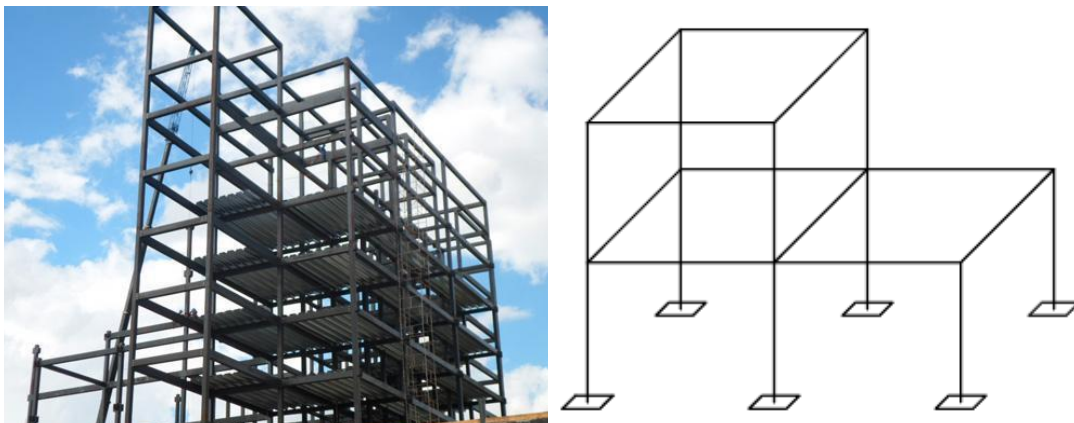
Estrutura de um edifício construído com elementos de aço e uma representação típica desse sistema estrutural.
